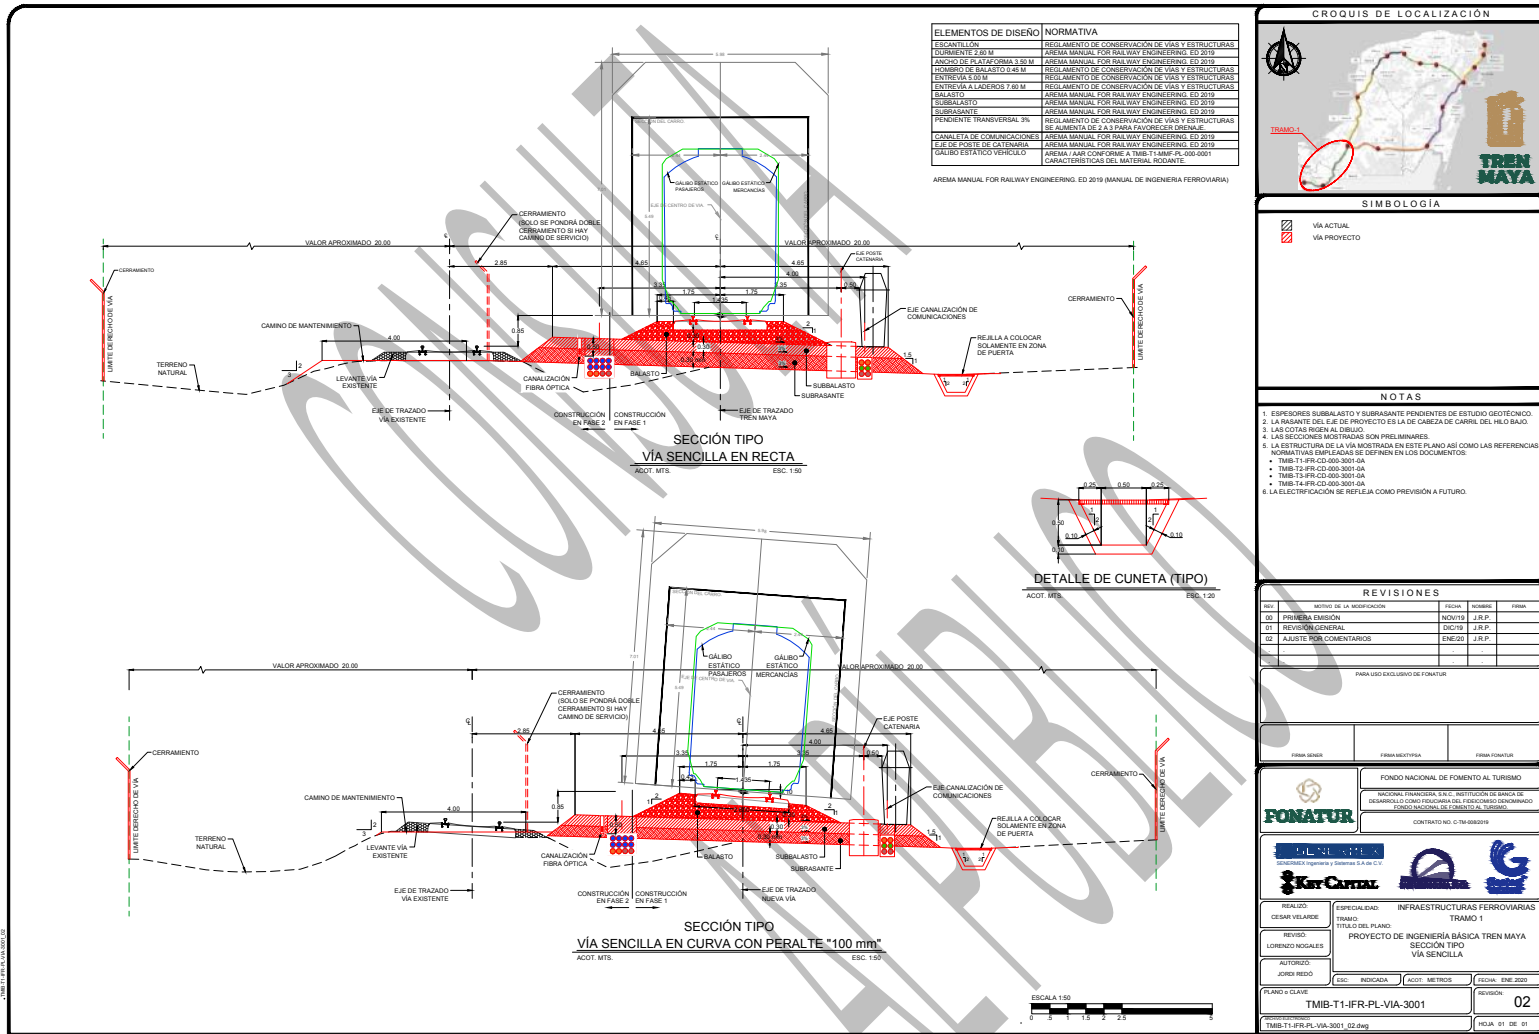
Plano del corte de la sección del tipo de vía ferroviaria
